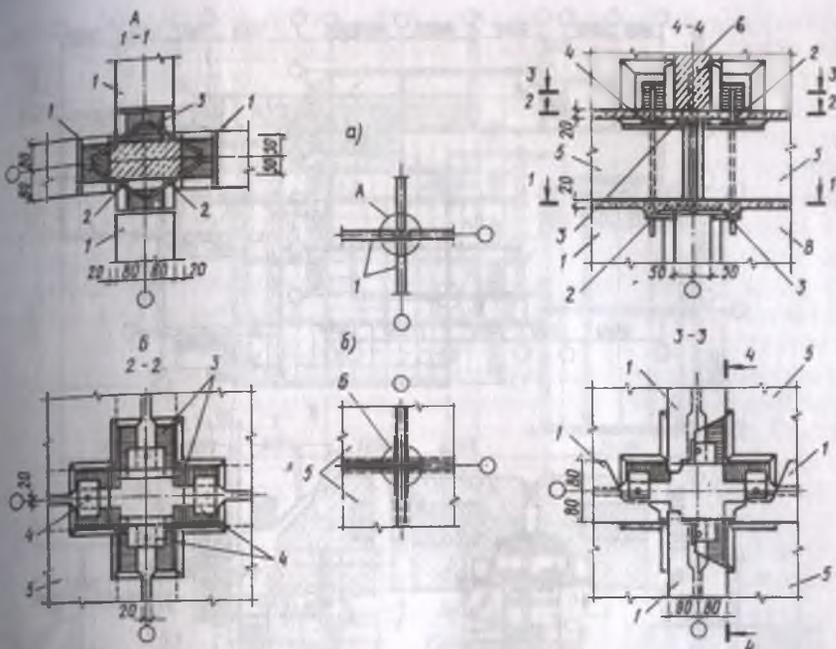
Узлы сопряжений внутренних конструктивных элементов здания: а — схема ситуационного плана в уровне внутренних стен; б — то же, в уровне перекрытия; 1 — панель внутренней стены; 2 — соединительные стержни; 3 — закладная деталь; 4 — соединительные пластины; 5 — панель перекрытия; 6 — мелкозернистый бетон
